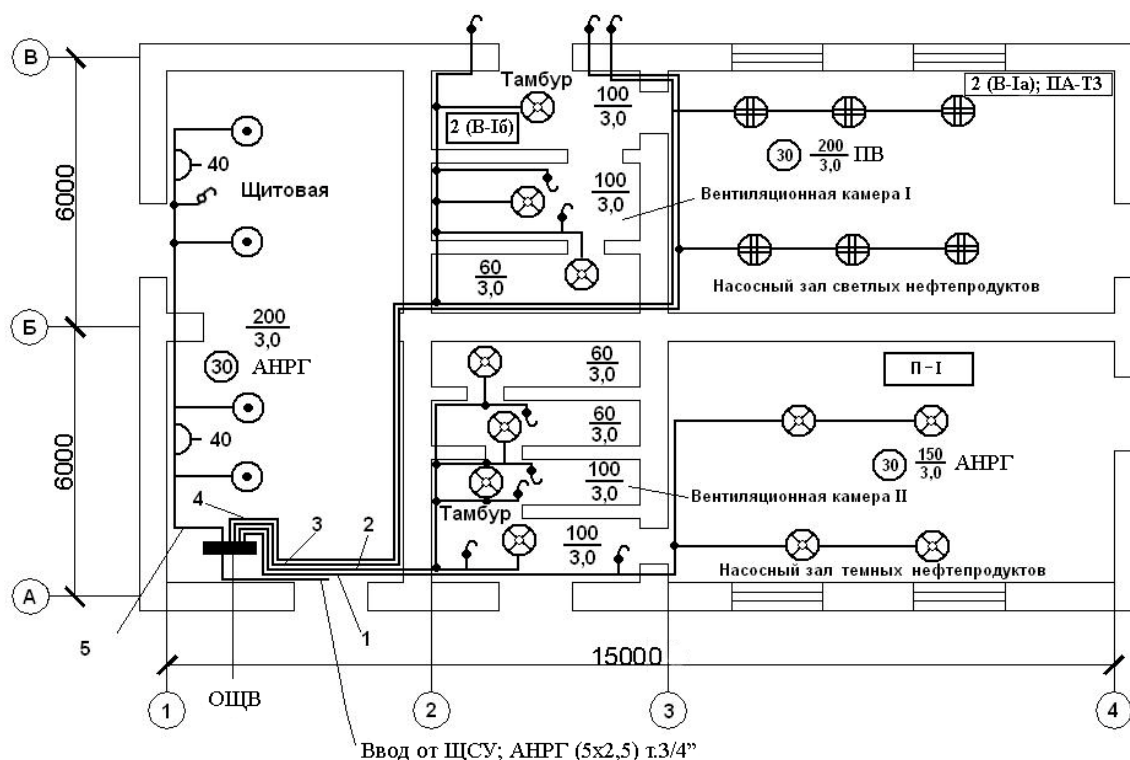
План расположения помещений и осветительного электрооборудования здания насосной станции:
